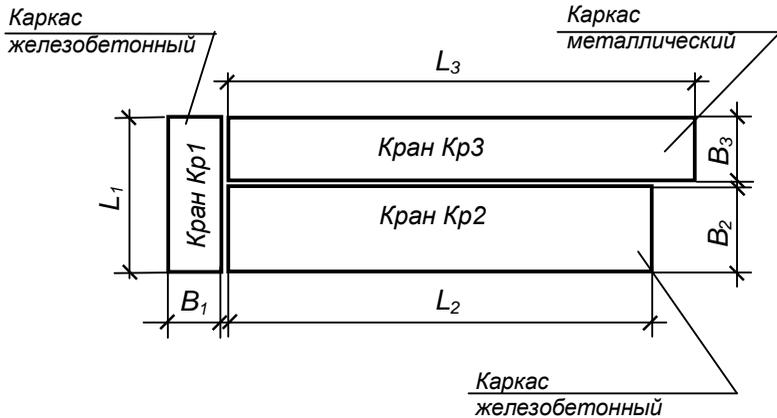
Схема плана промышленного здания на отс. 0,000
